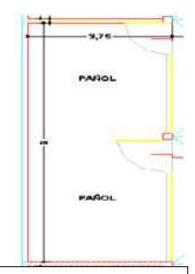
y fig.41 – Sector de Pañol, tipo de Iluminación y plano en Planta (fig.41).
